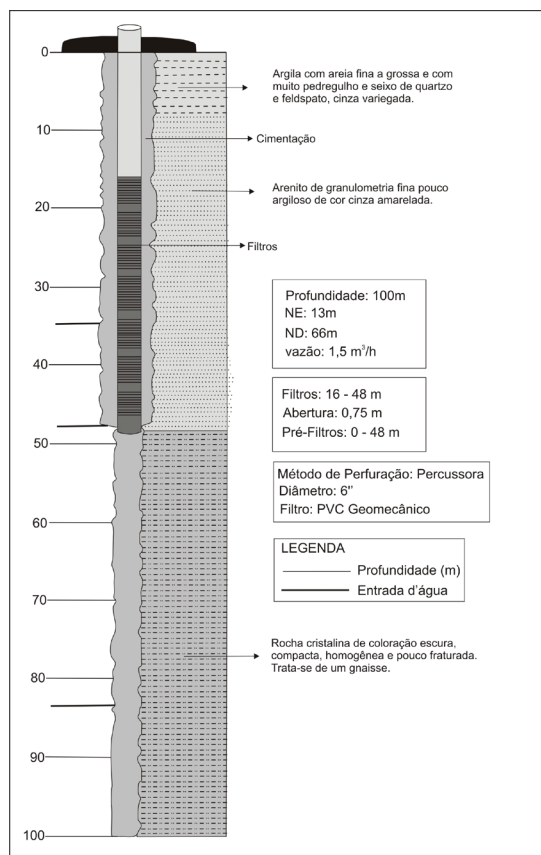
Perfil construtivo e litológico do poço tubular nº 36 - Campus do Pici/UFC
